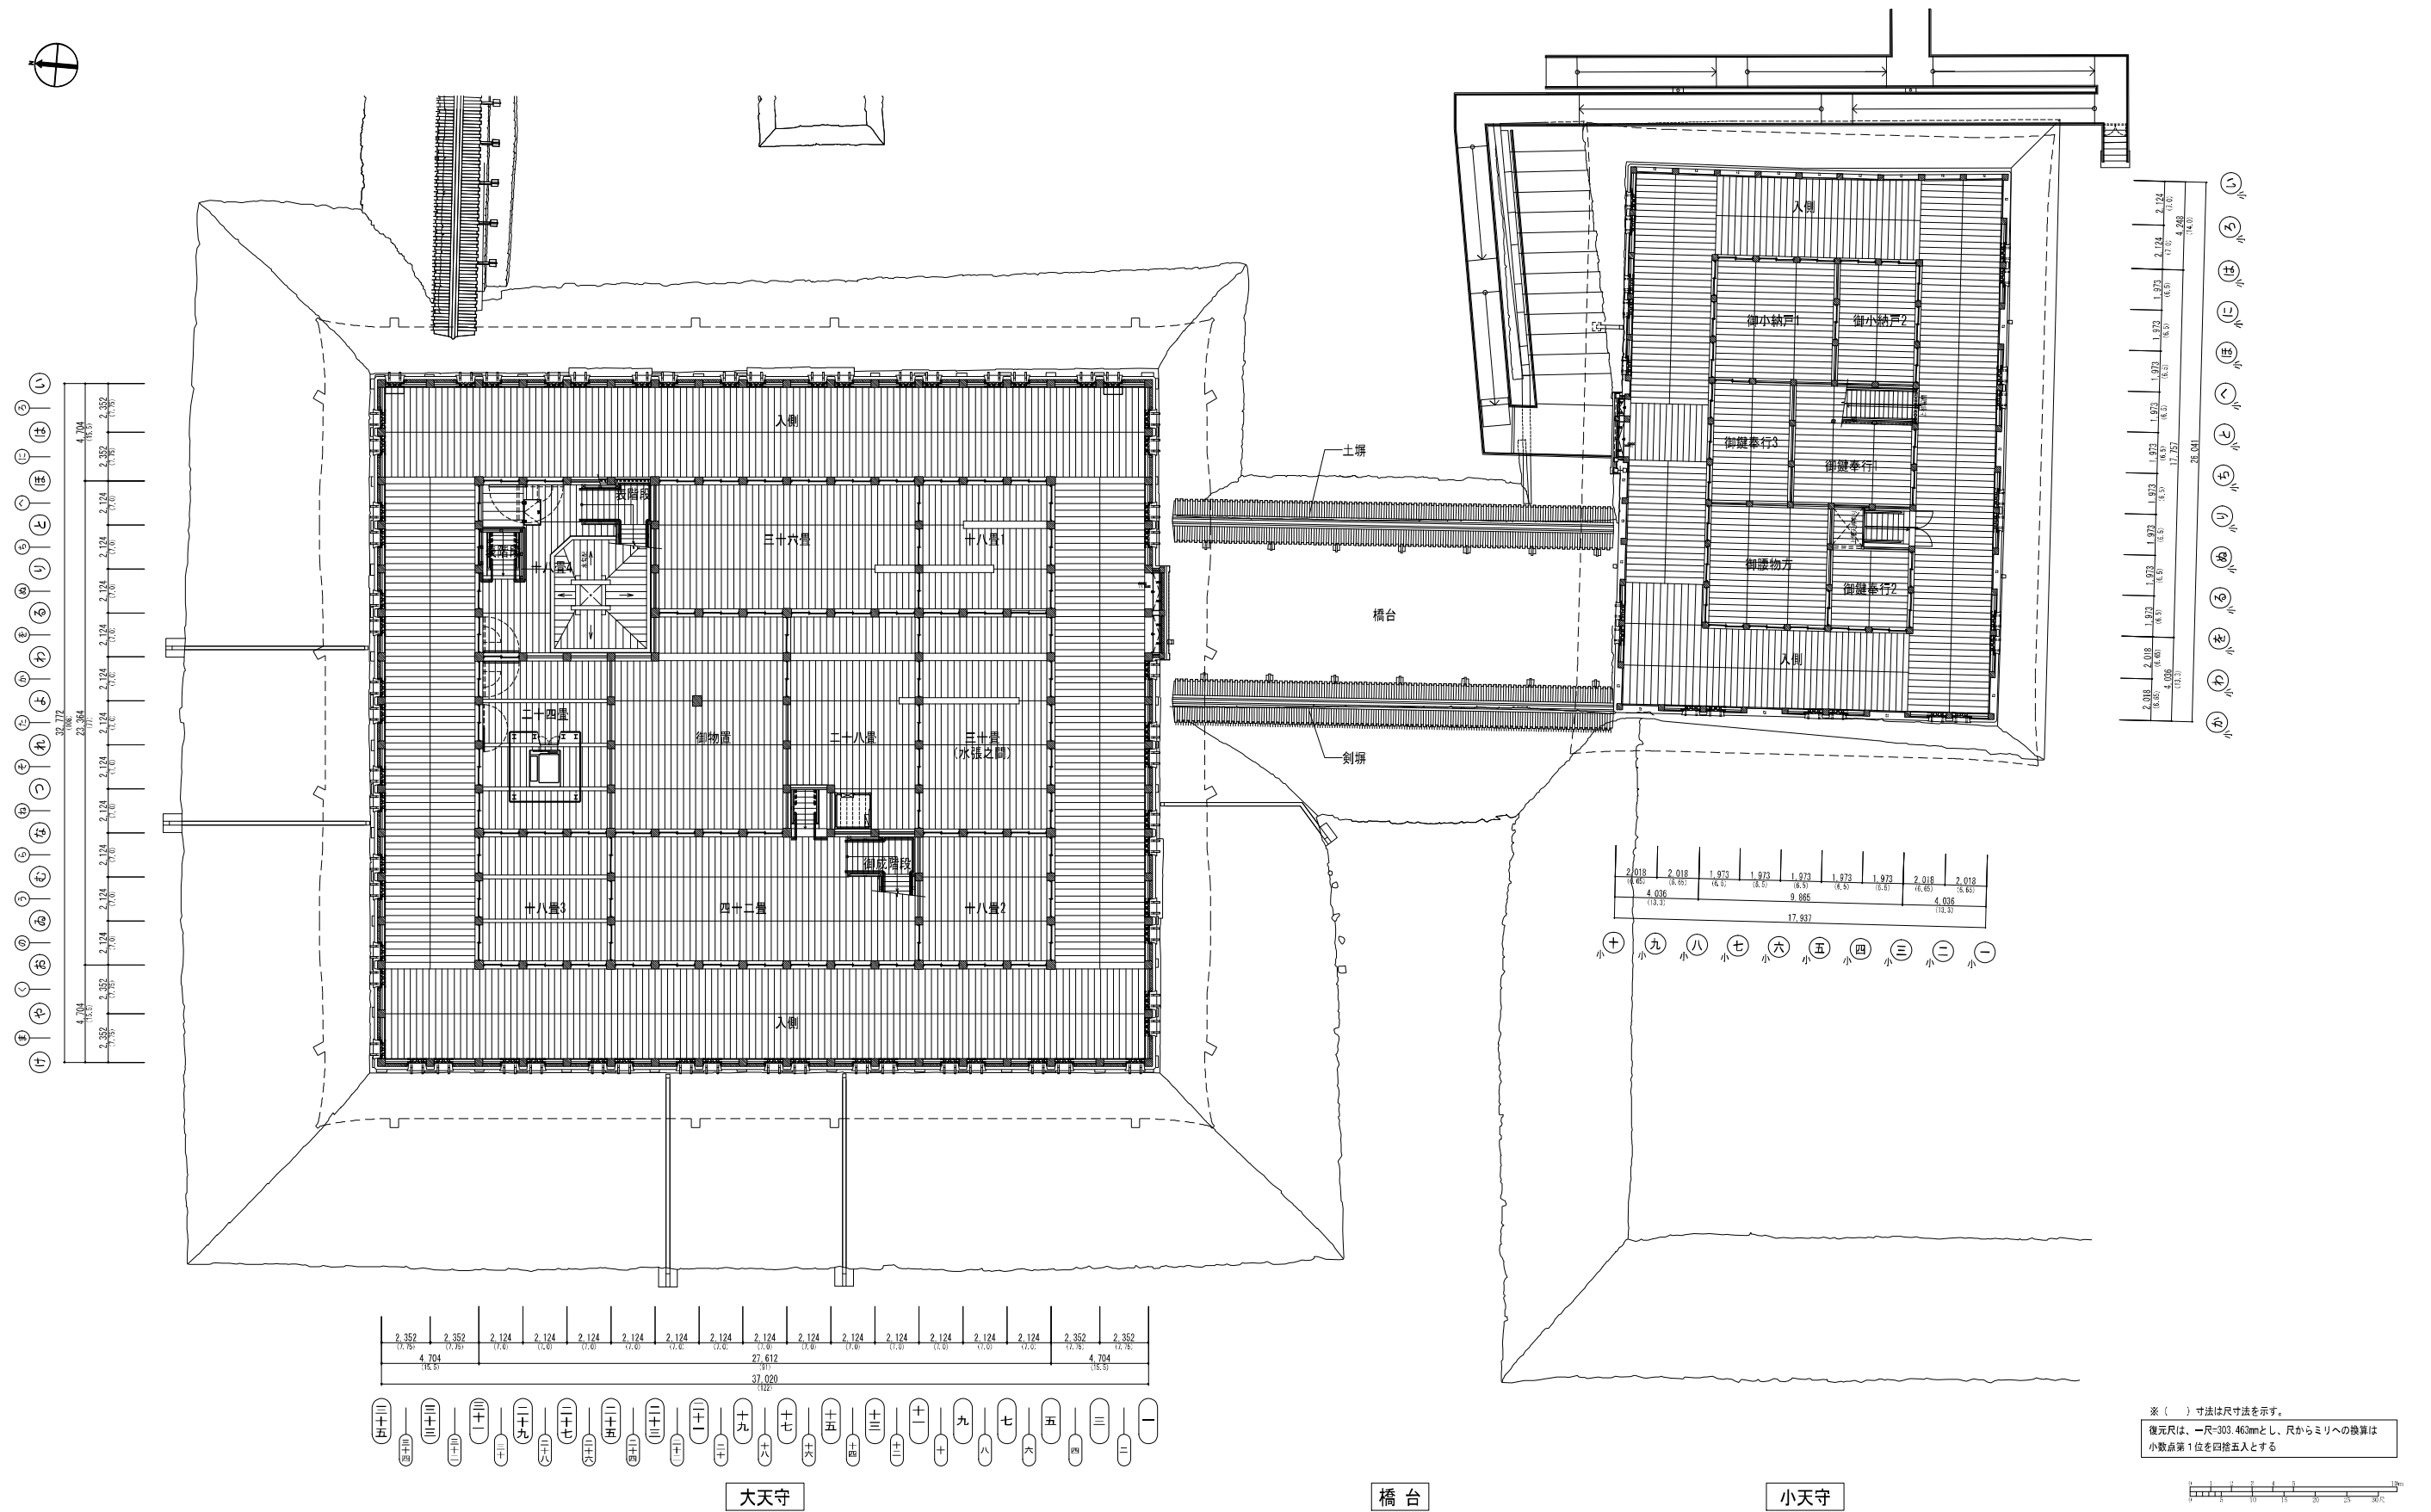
大小天守1階平面図及び橋台屋根伏図
